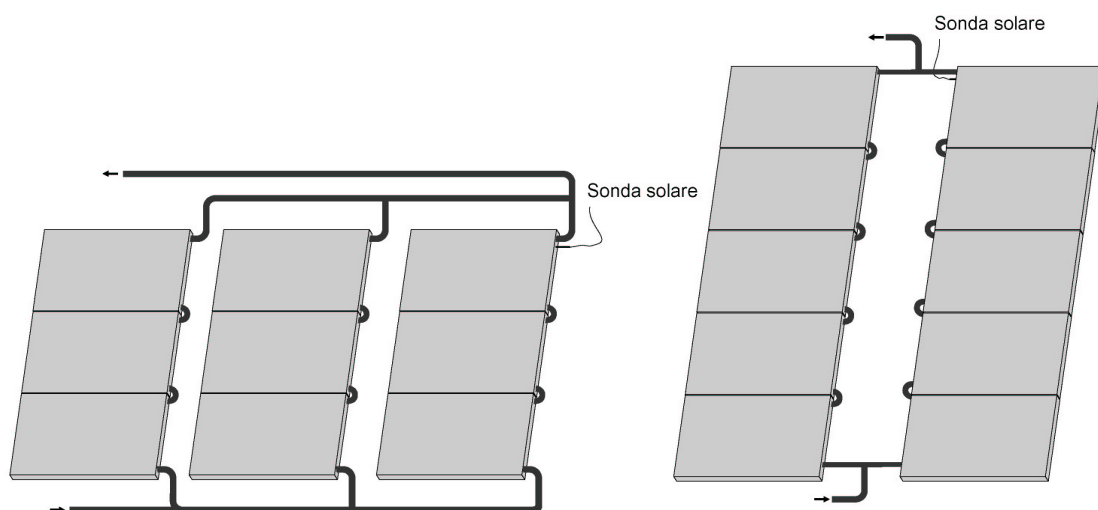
Combinazione di collegamenti serie e parallelo ad orientamento orizzontale
